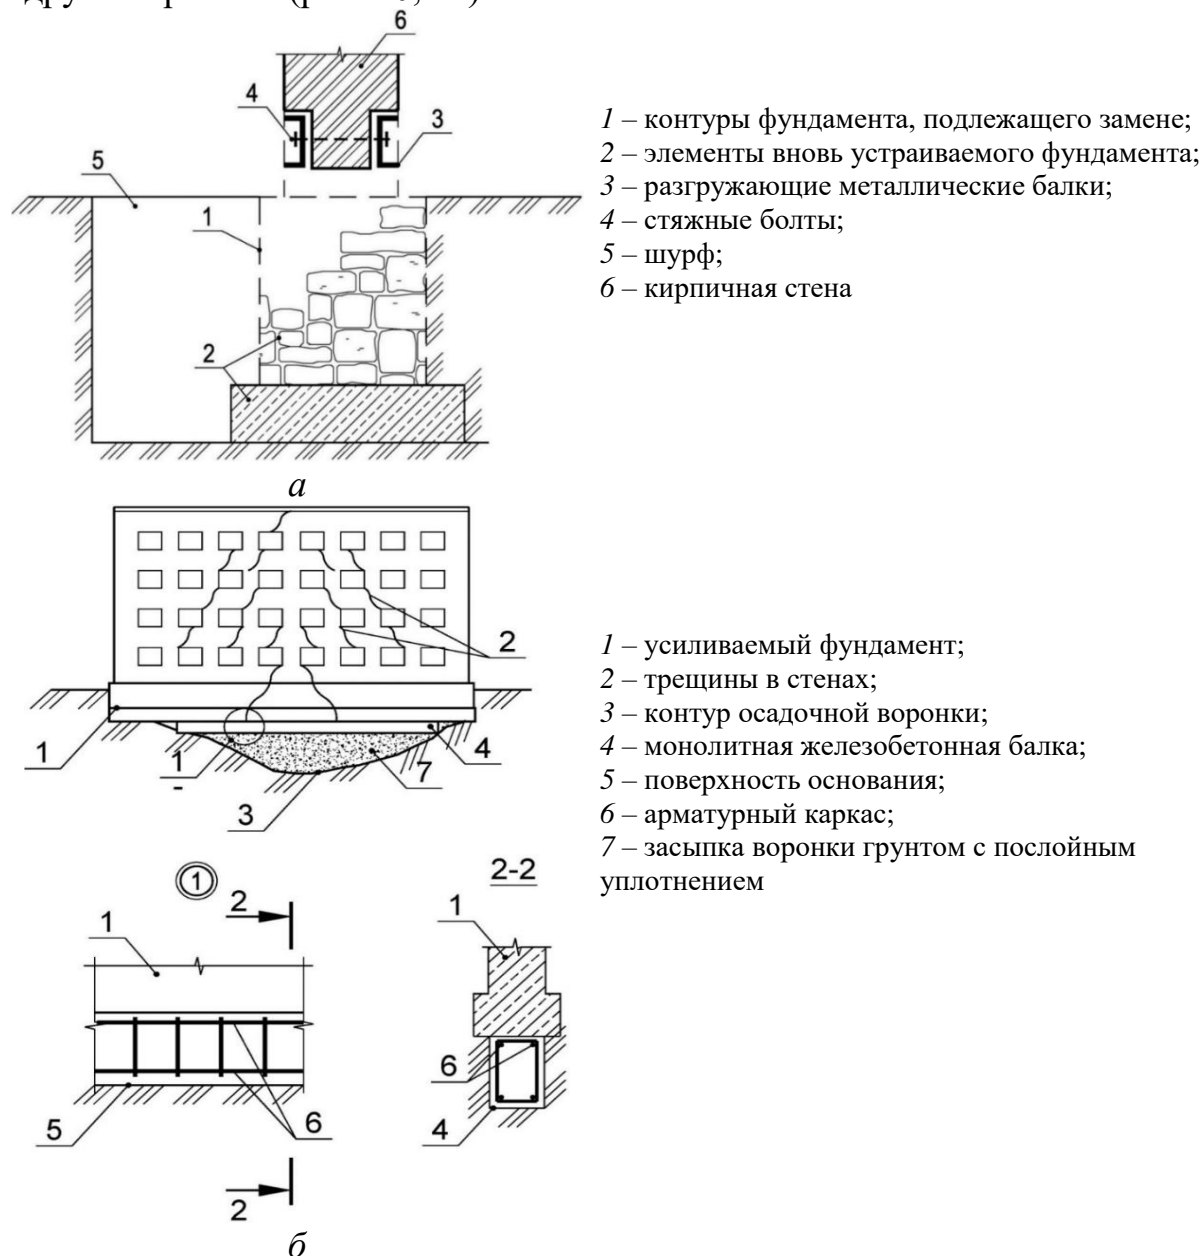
Разгрузка конструкций фундаментов путем подведения несущих балок под участки здания:
